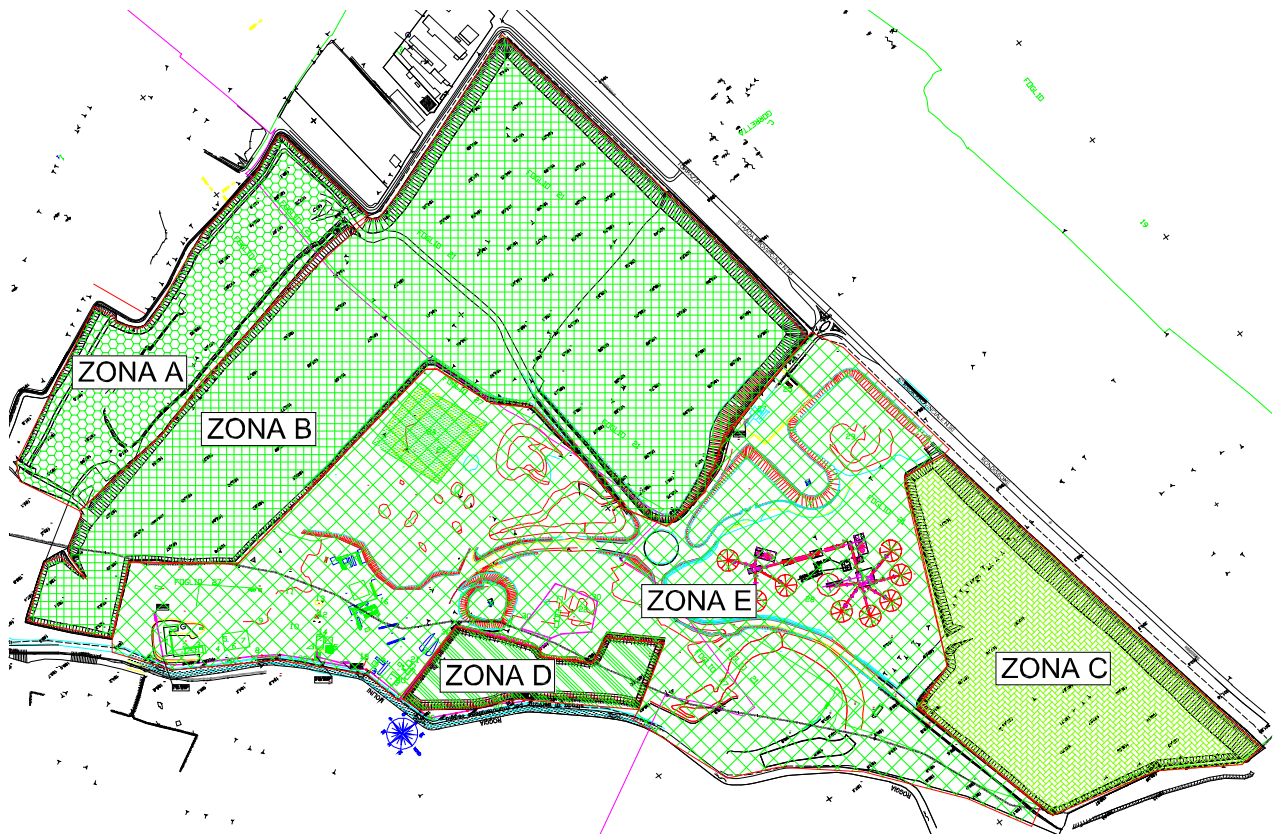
Planimetria area estrattiva di Torrazza Piemonte
